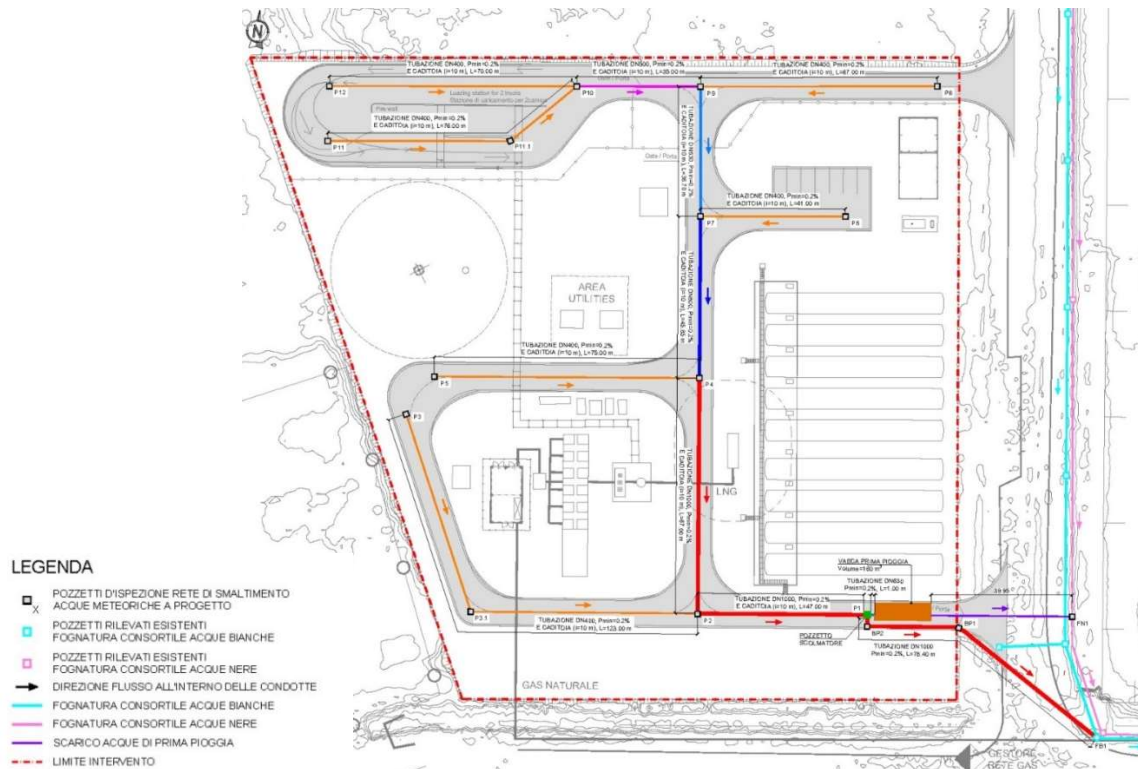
Planimetria Rete Smaltimento Acque Meteoriche
